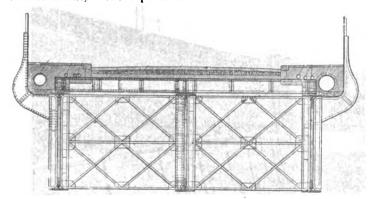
Cavalcavia di Mill-Lane - Sezione.
